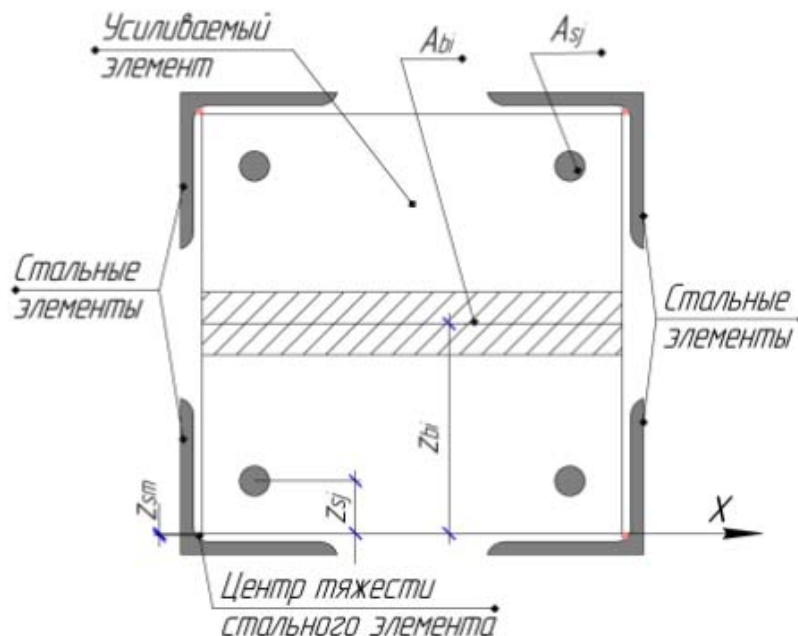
Расчетная схема нормального сечения железобетонного элемента, усиленного присоединением стальных элементов (уголков)
